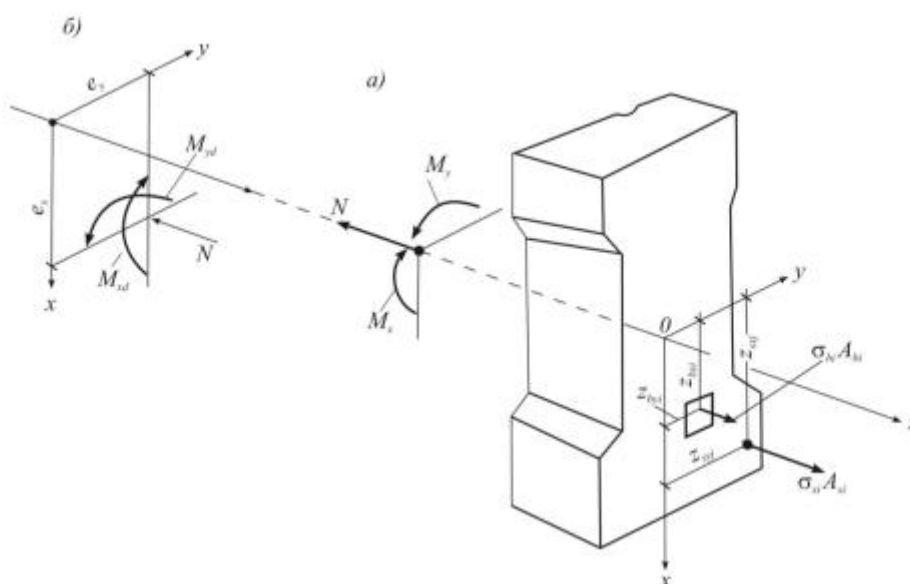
Схема железобетонного элемента нормального сечения по СП 63.13330.2018
